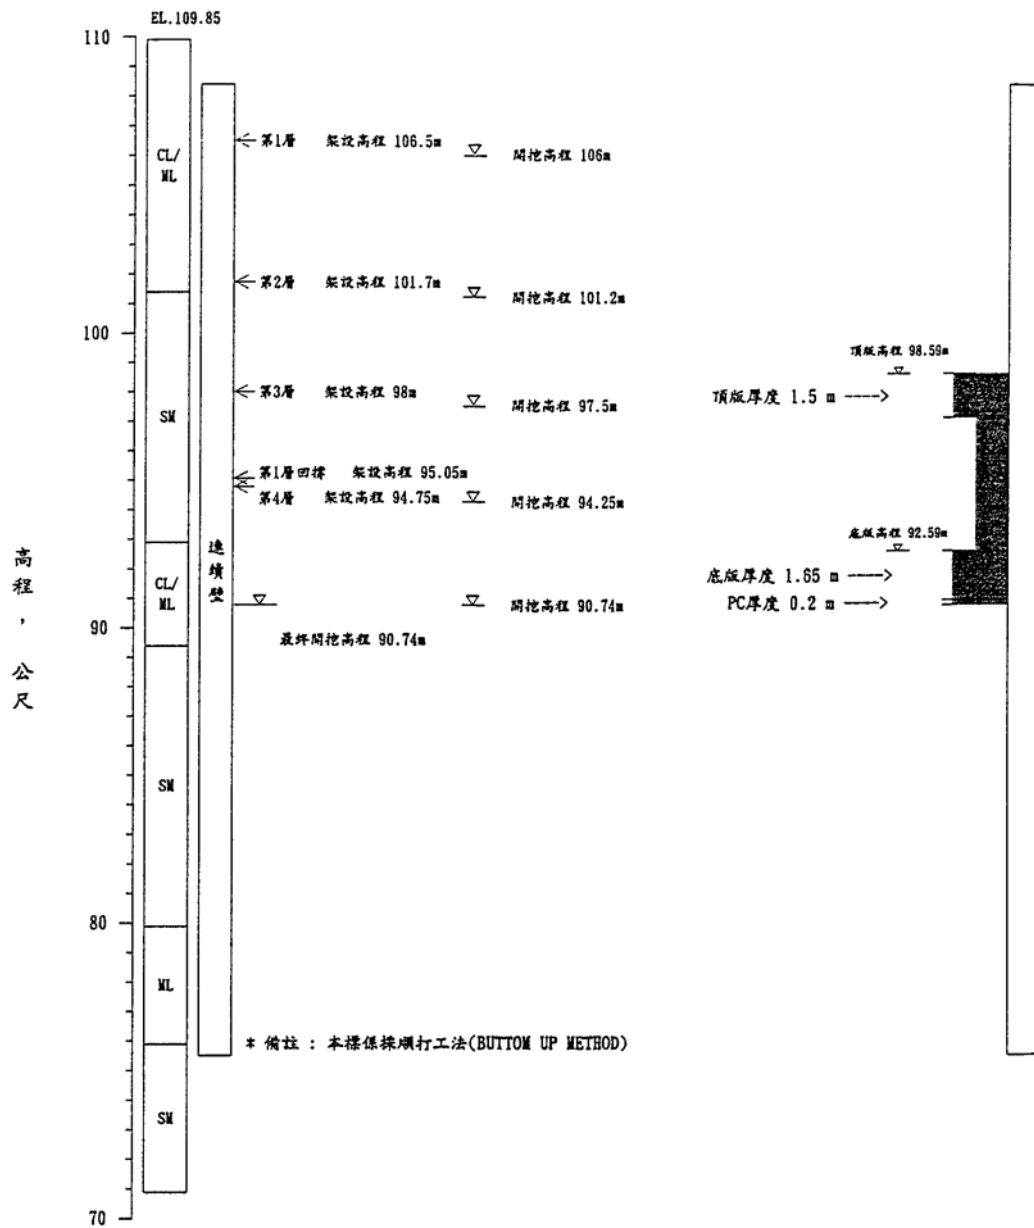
明挖覆蓋隧道施工剖面 (分區 B03)
